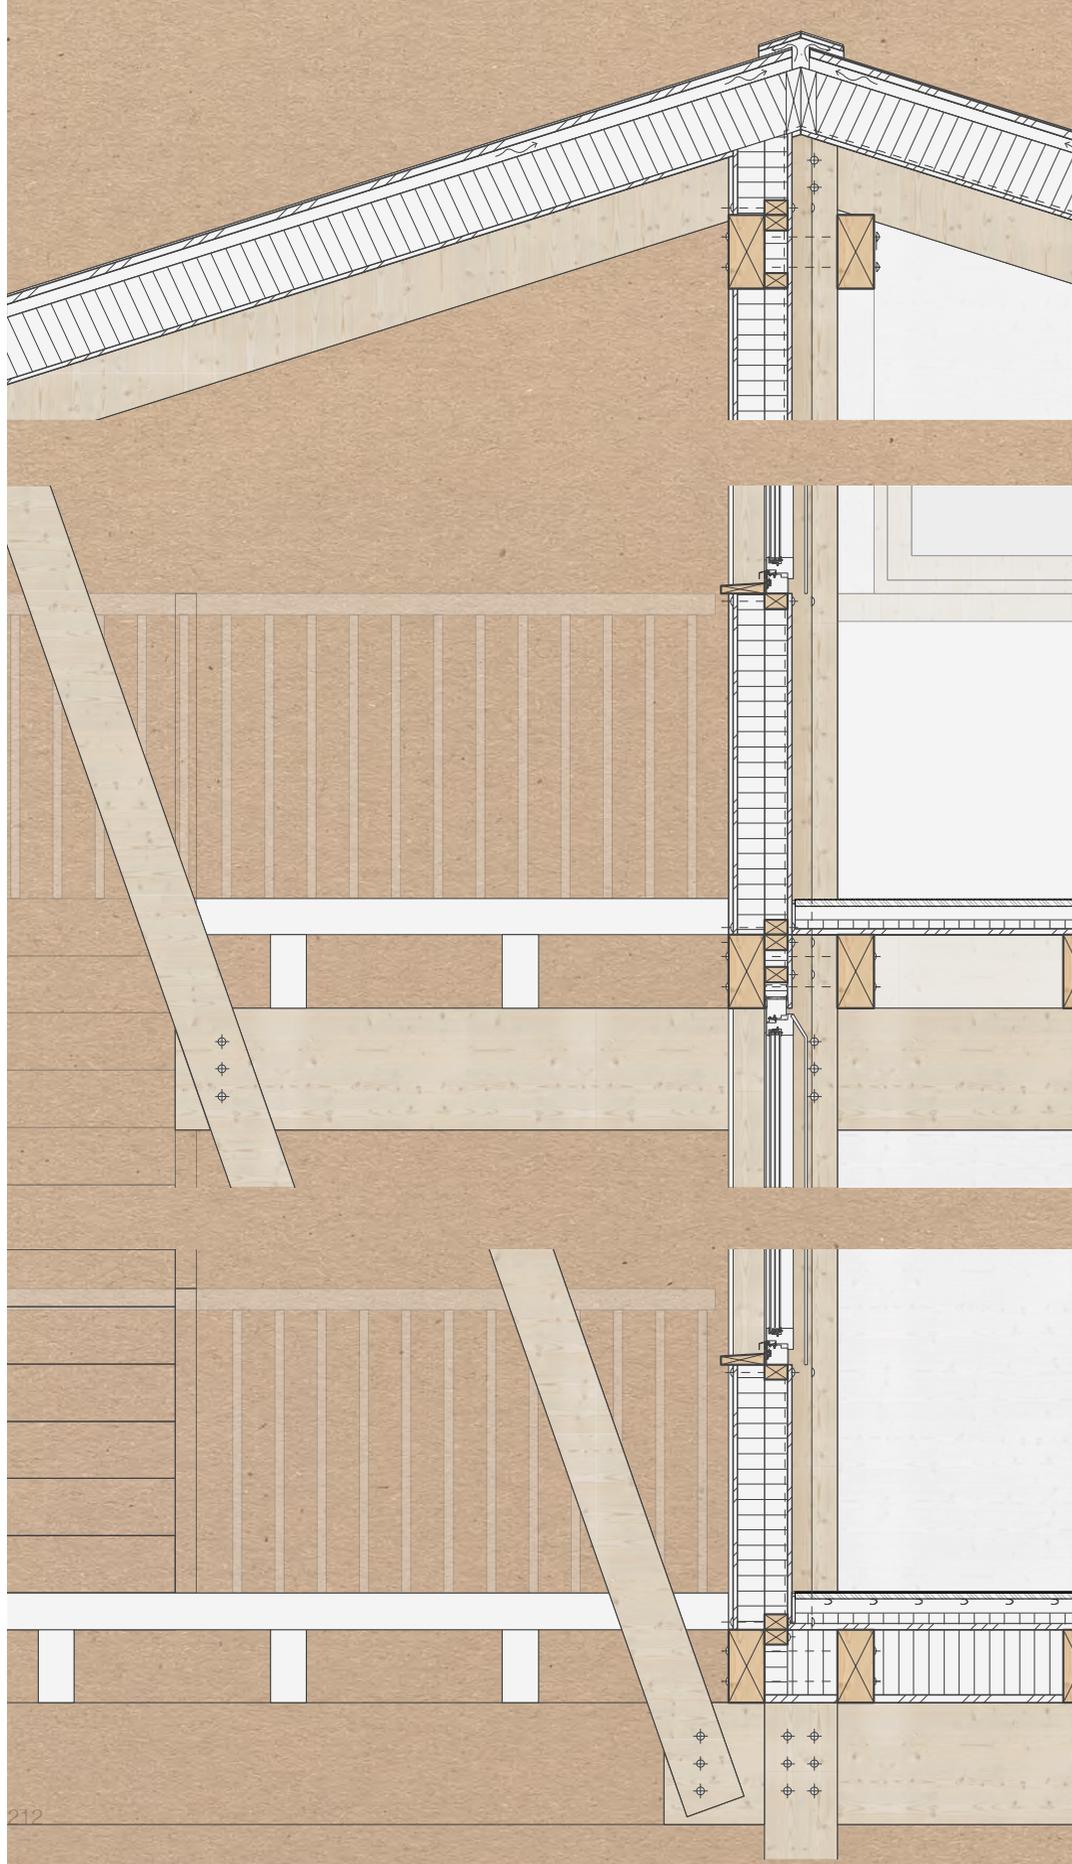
25 (REFERENZMASSSTAB 1:10)
